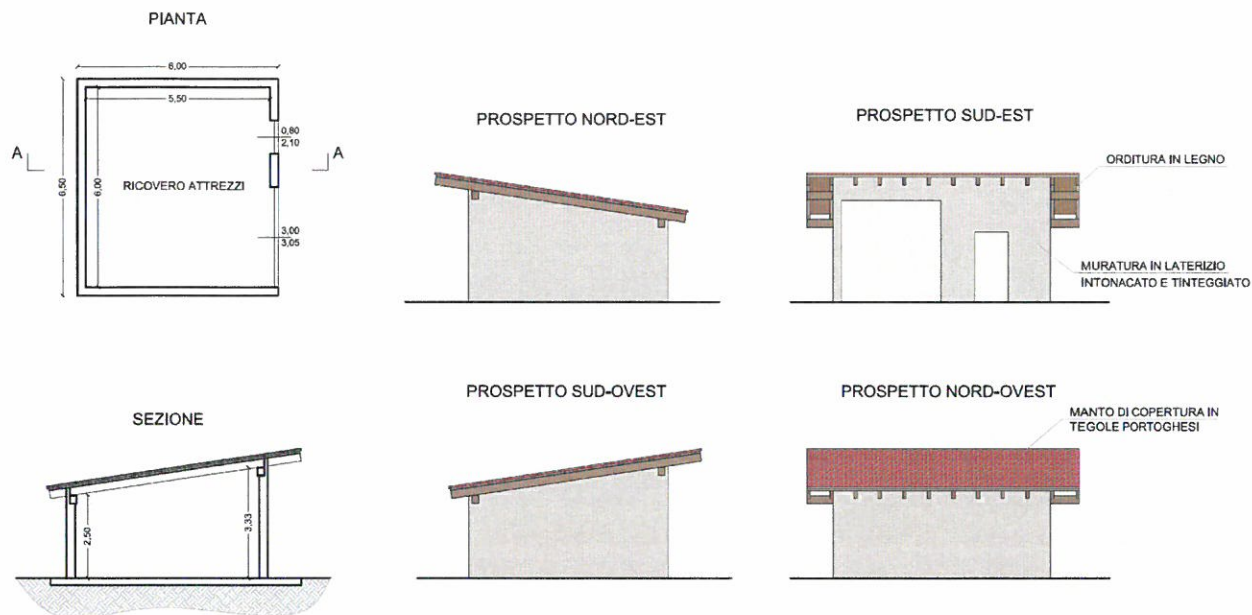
Ricovero attrezzi in progetto (Fabbr. "C" in planimetria generale)
